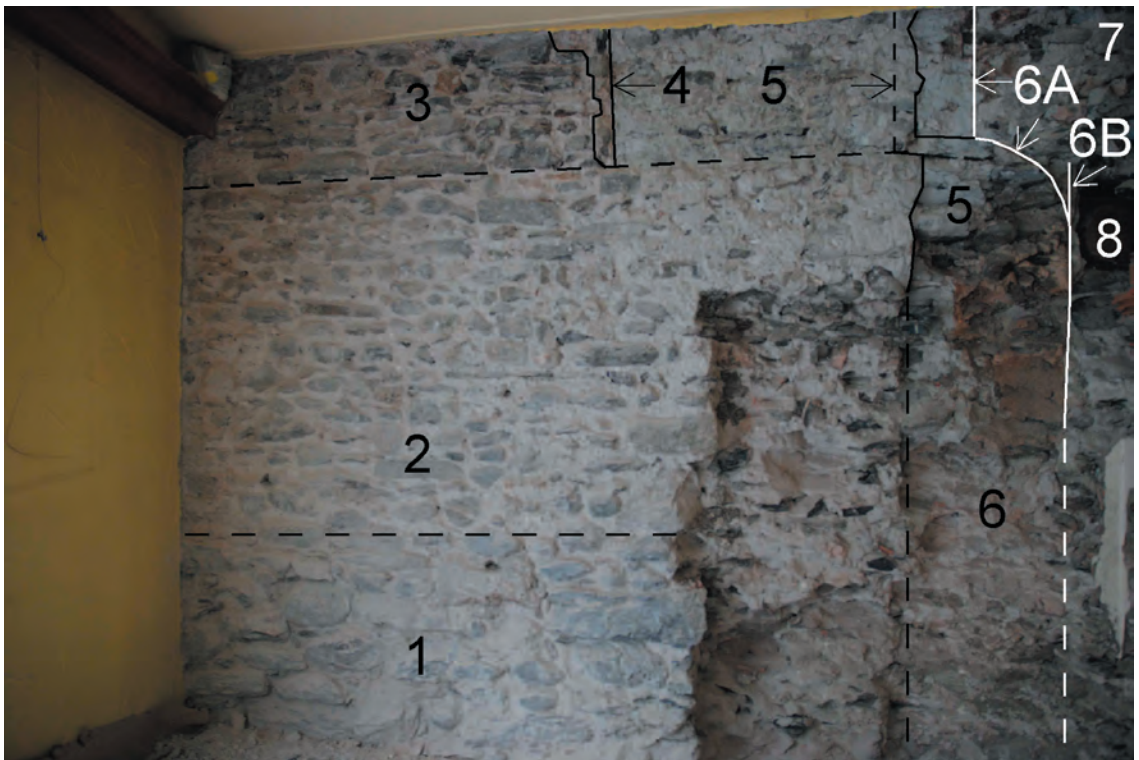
Rez-de-chaussée, restaurant salle nord, mur sud, partie est (2009).
